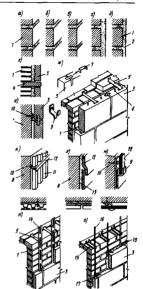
Отделка фасадов каменных стен. Швы кладки:
